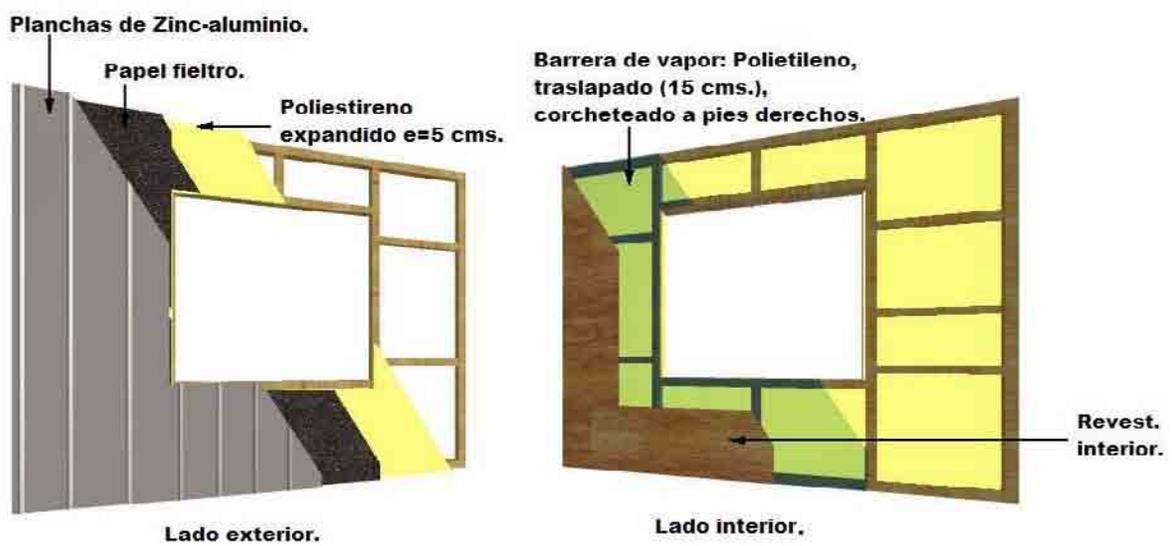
Vista esquemática, tanto externa como interna de tabique perimetral propuesto. Fuente: Elaboración propia.
